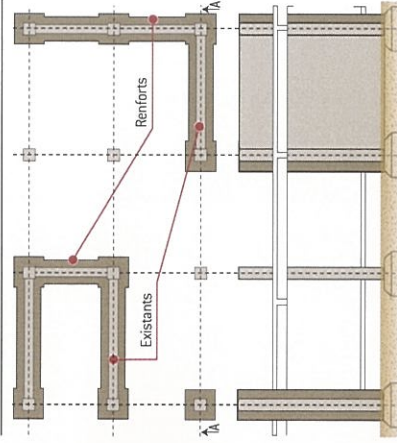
Exemple de renforcement de poteaux, murs, par chemisage en béton projeté (vue en plan et coupe AA)
